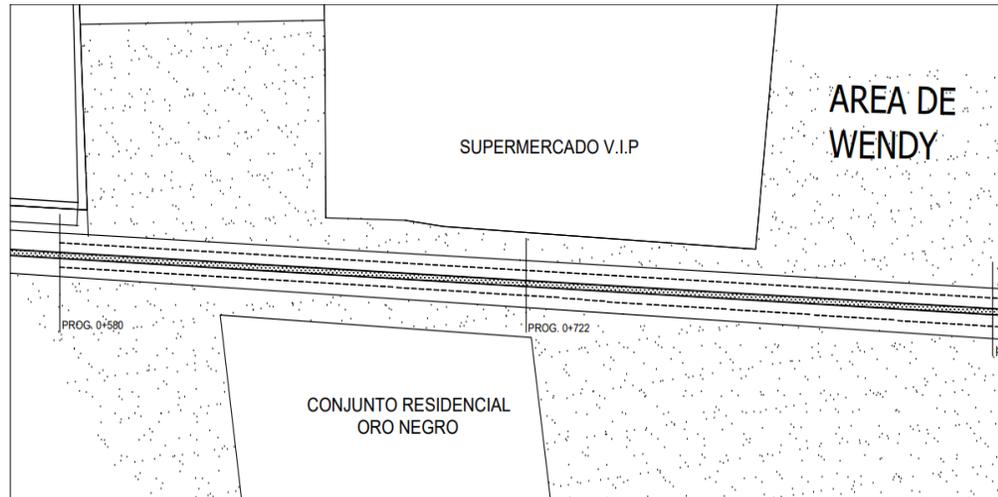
Perfil vista en planta 400m de la Avenida Intercomunal.
